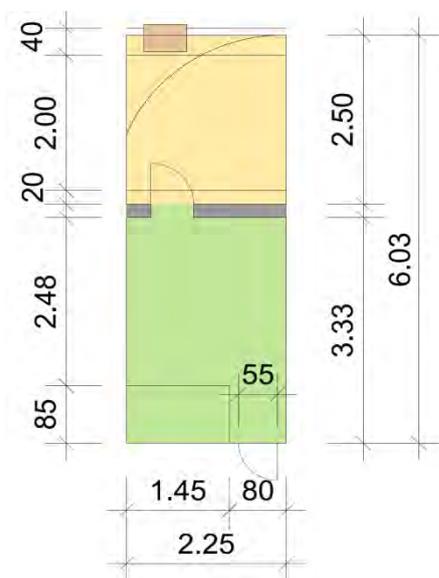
Grundriss der Abferkelbucht des Modellstalls mit Außenfütterung
